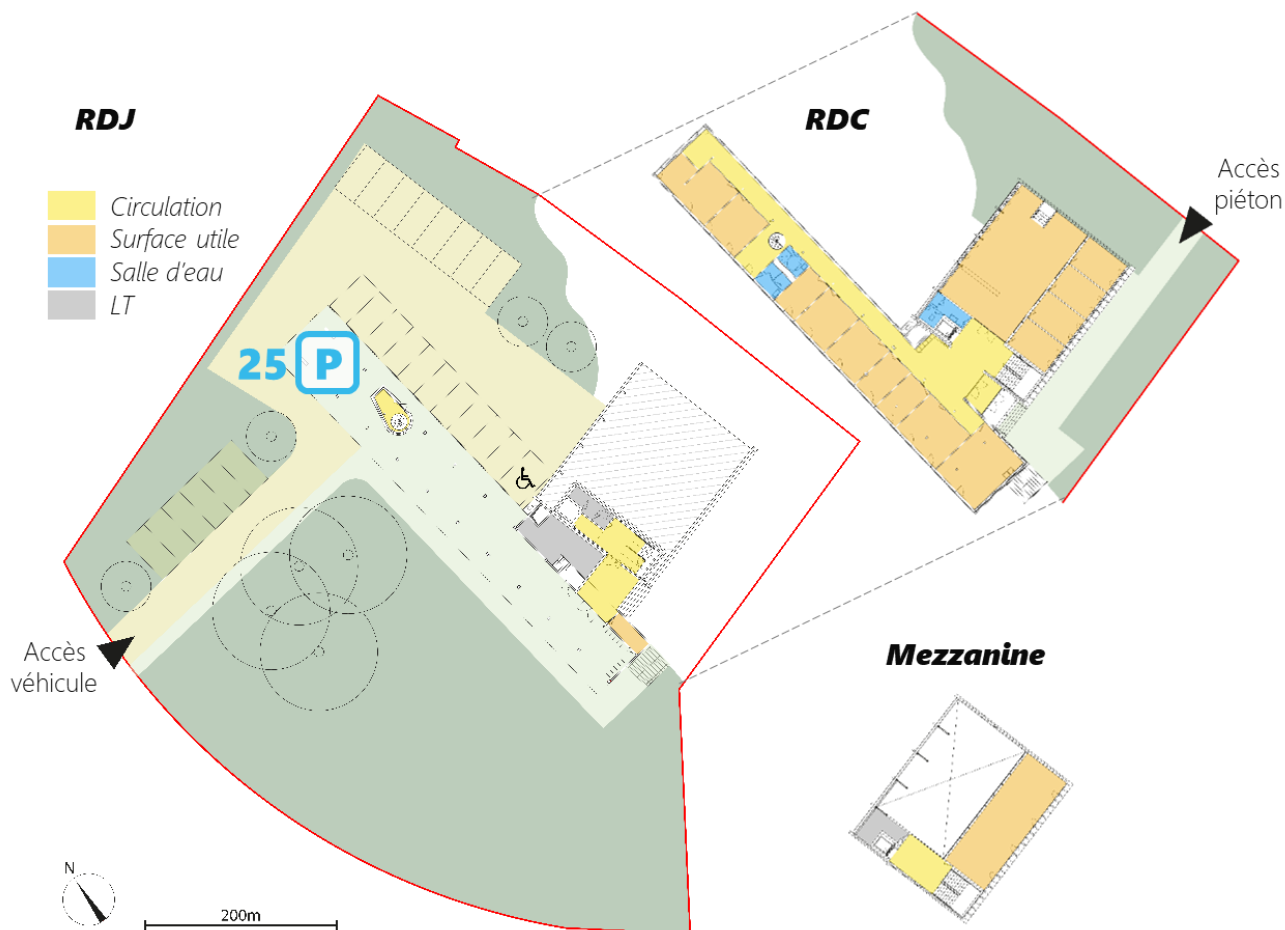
Organisation du site – Source : Egis sur fond de plan Carrière Didier Gazeau Architecte
